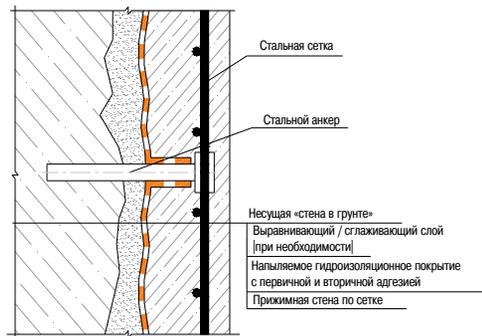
Устройство гидроизоляционной системы при открытом способе работ с использованием стены в грунте в качестве несущей. Узел 3
